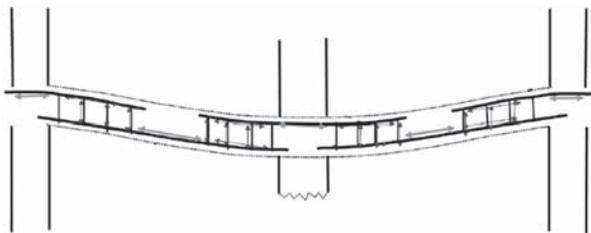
Работа железобетонных конструкций перекрытия в условиях предельного состояния при традиционном проектировании
